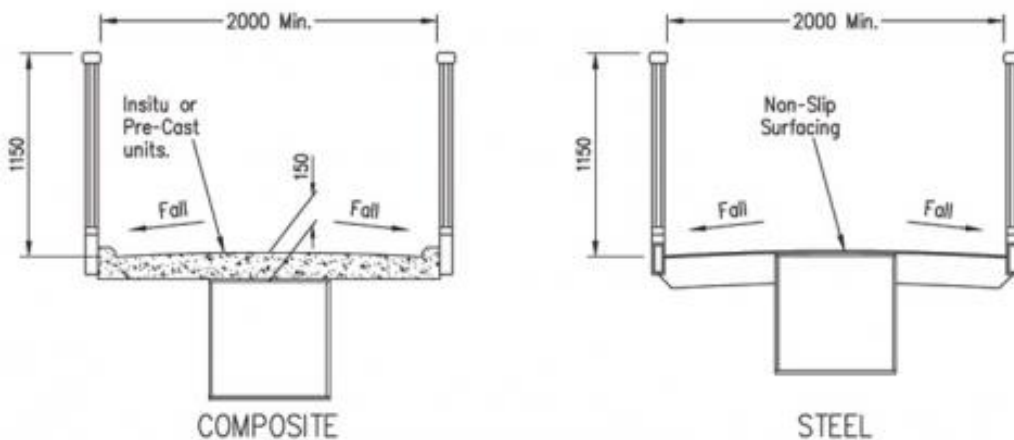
Caixões para pontes pedonais (www.steelconstruction.info)
